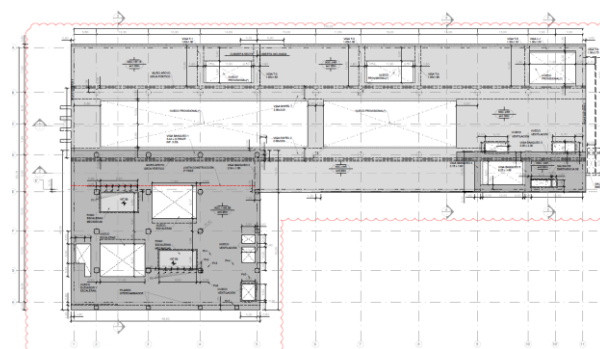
Planta losa cubierta (nivel calle) del proyecto para proceso constructivo acelerado.
